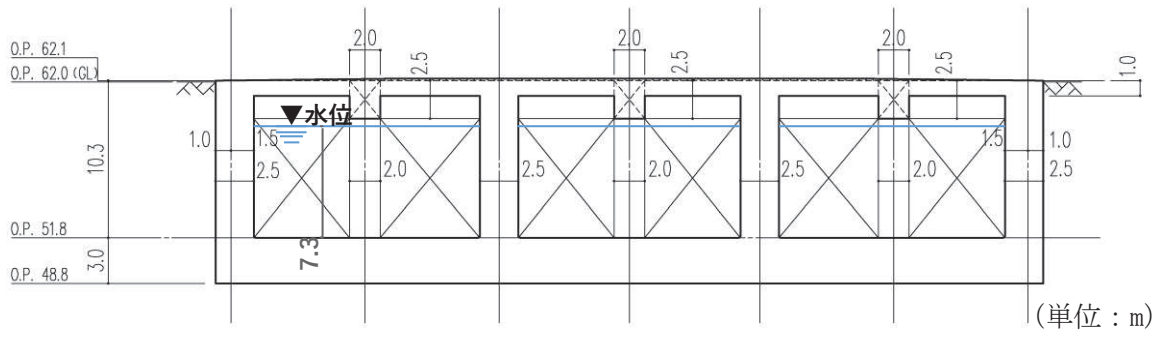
(1) 淡水貯水槽の概略断面図 (A-A 断面 EW 方向)
